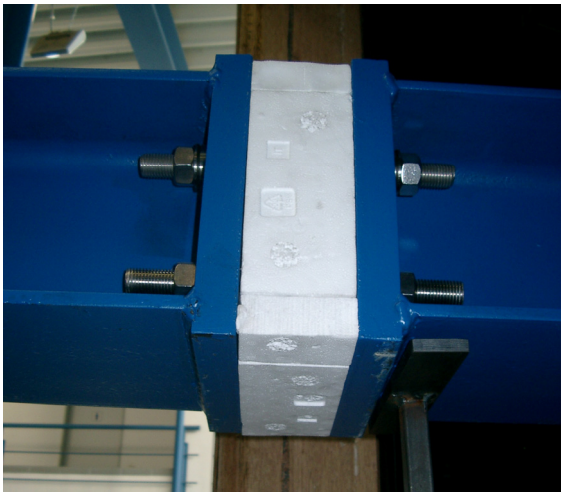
Anschluss Stahlträger HEA 220 mit Schöck Isokorb Typ KST 22
